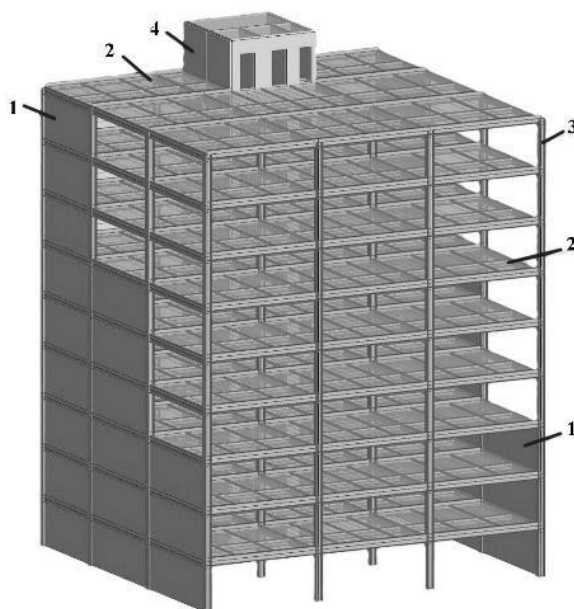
Пример комбинированного каркаса из металлических конструкций, с железобетонным ядром жесткости, со стеновыми дисками и перекрытиями из деревянных панелей: 1 – стеновые деревянные панели; 2 – деревянные панели перекрытия; 3 – стальной каркас; 4 – железобетонное ядро жесткости
